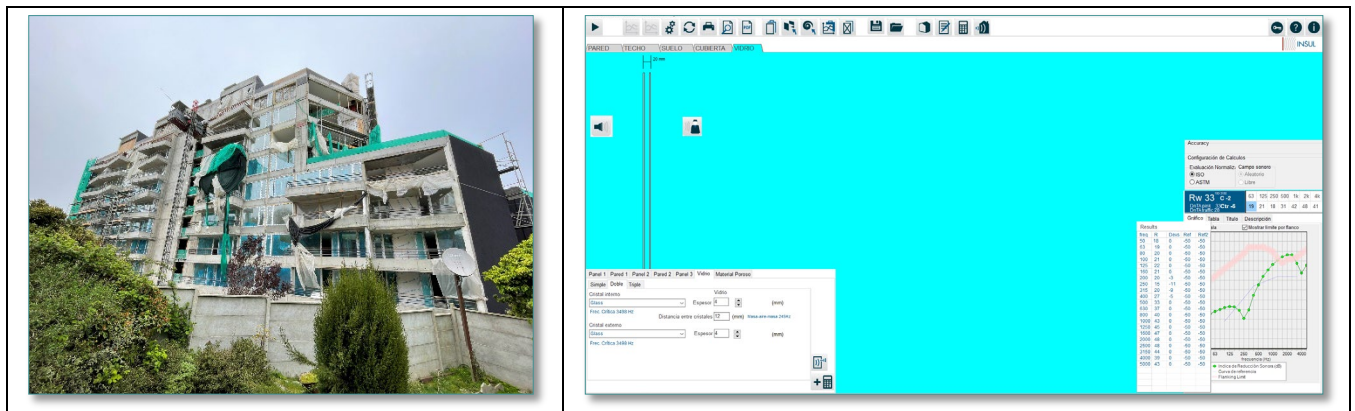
; Ubicación barreras acústicas flexibles para Construcción Edificio. Fuente: Elaboración propia. -)
